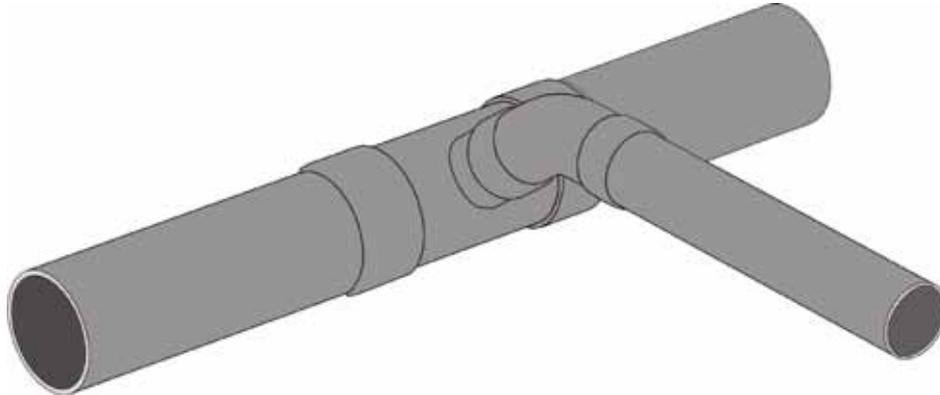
Raccordement sous un certain angle de canalisations d'égout à faible débit, faible couverture ou très forte pente.
